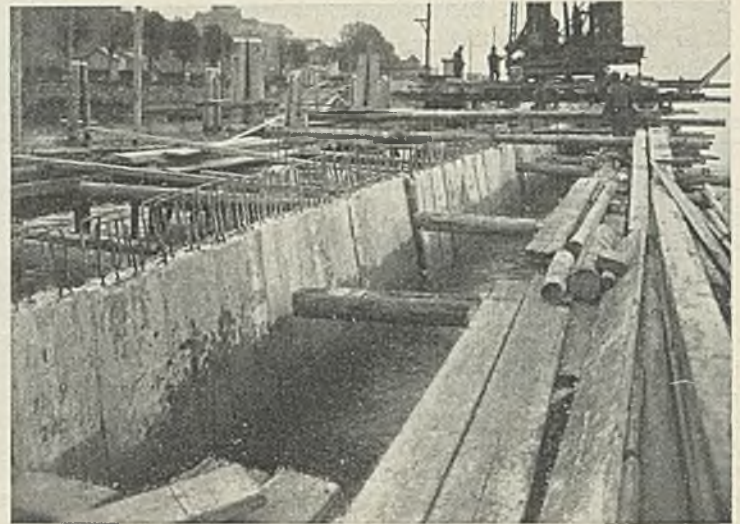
Die Eisenbetonspundwand während der Ausführung (Außenansicht).
